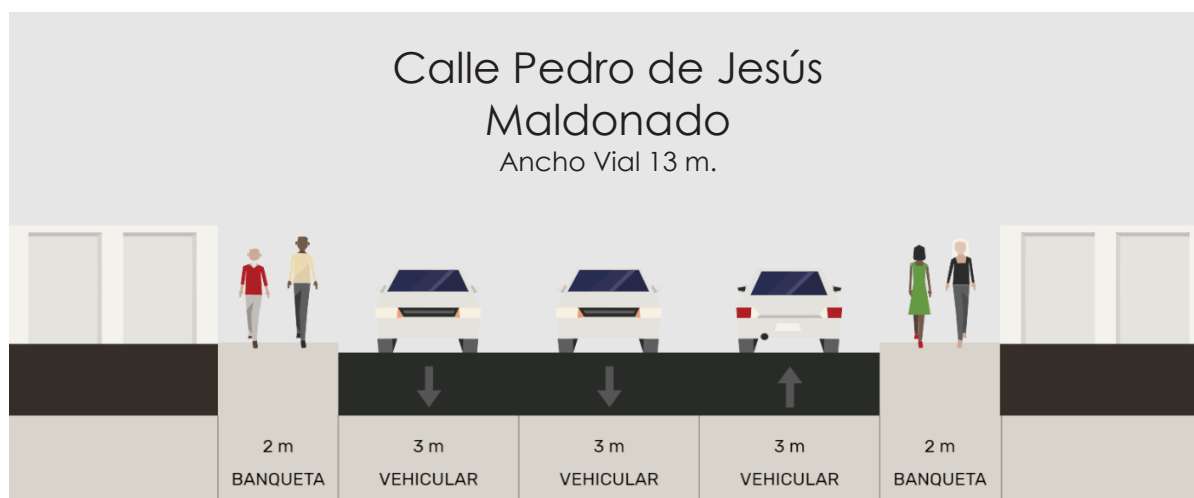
Sección vial propuesta para Calle Pedro de Jesús Maldonado.
